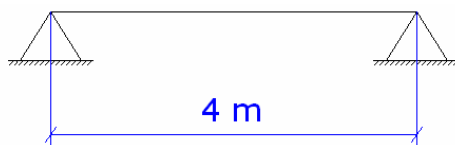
Detalle del hueco a cubrir en la cubierta.
